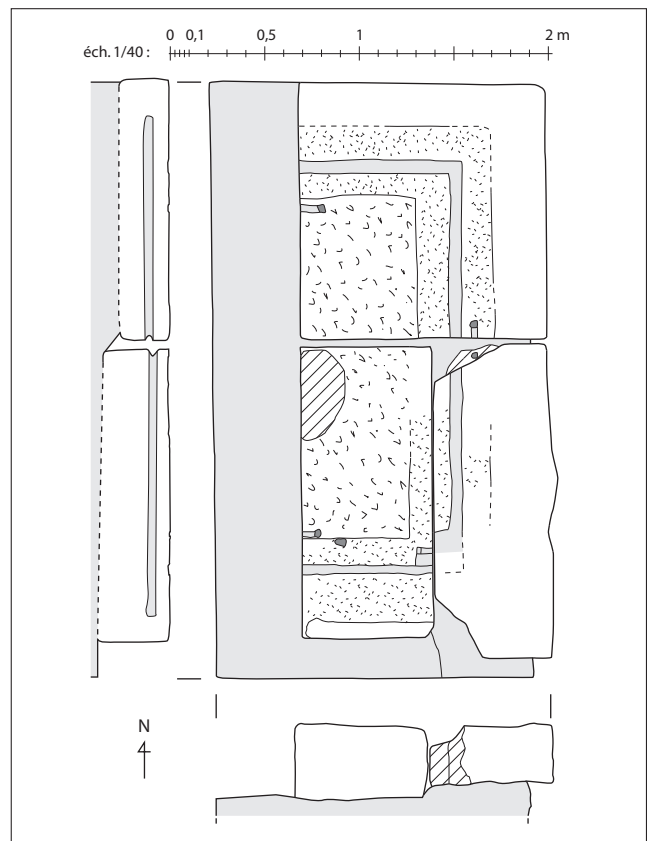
Plan du soubassement de la fontaine de l'Odéon (J. Ramona, SAVL).
